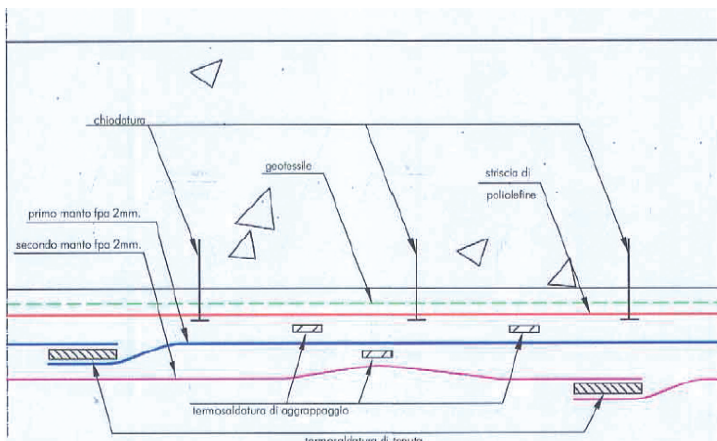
Dettaglio modalità di posa impermeabilizzazione controsoletta zona di attraversamento fiume. Detail of the method of positioning of the counter-slabbing waterproofing in the area of the river underpass (riveting; geofabric; polyolefin strip; first coating fpa 2 mm; second coating fpa 2 mm; thermowelding of fixings; thermowelding of seal).
